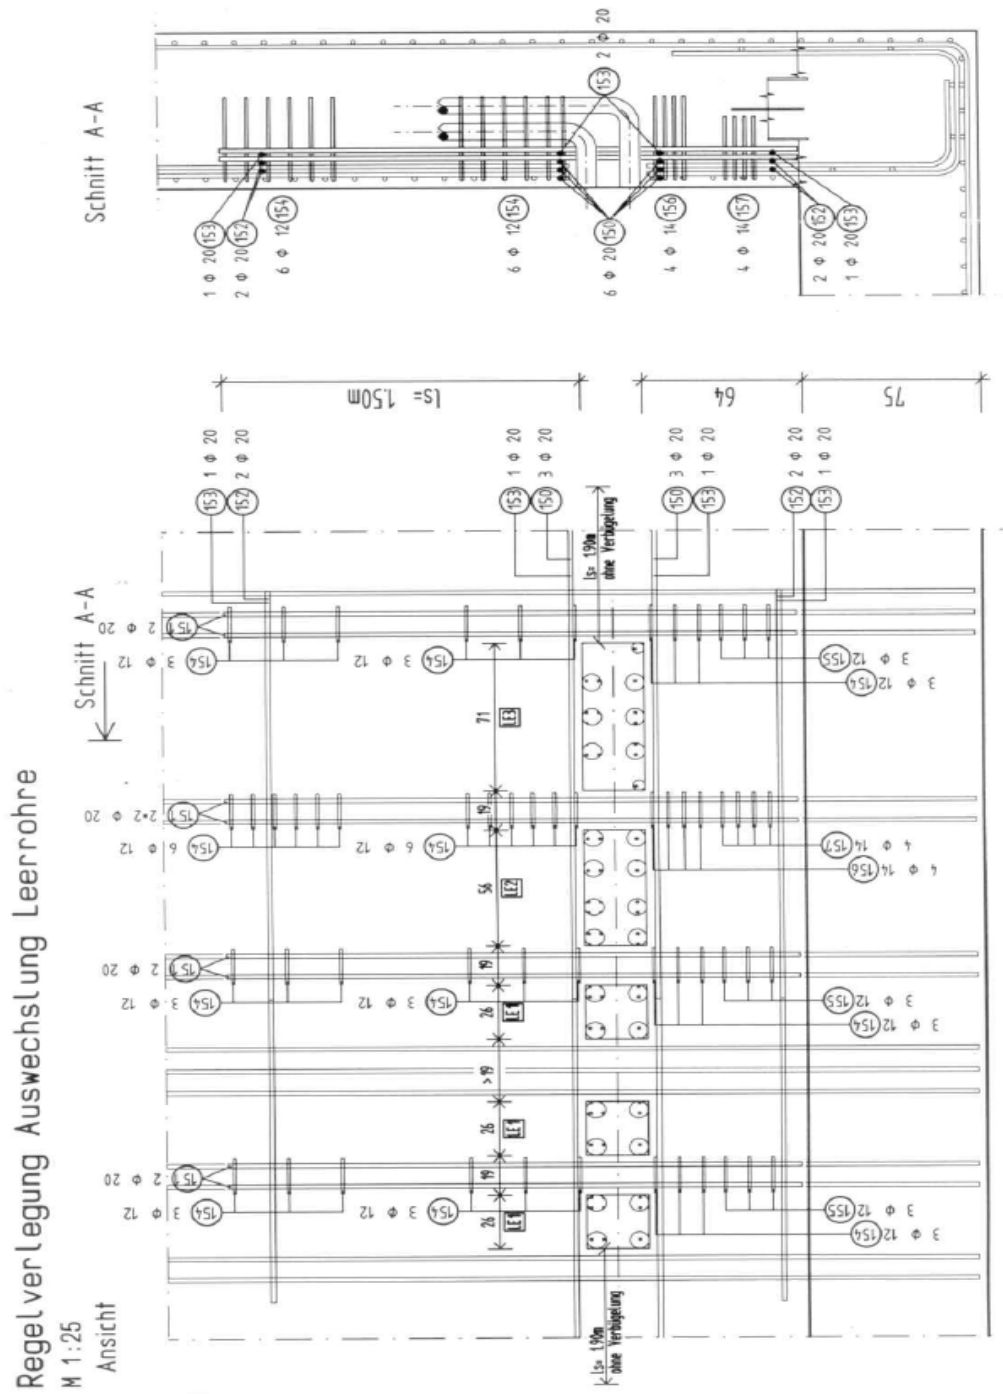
Bewehrungsauswechslung Leerrohrdurchdringung
